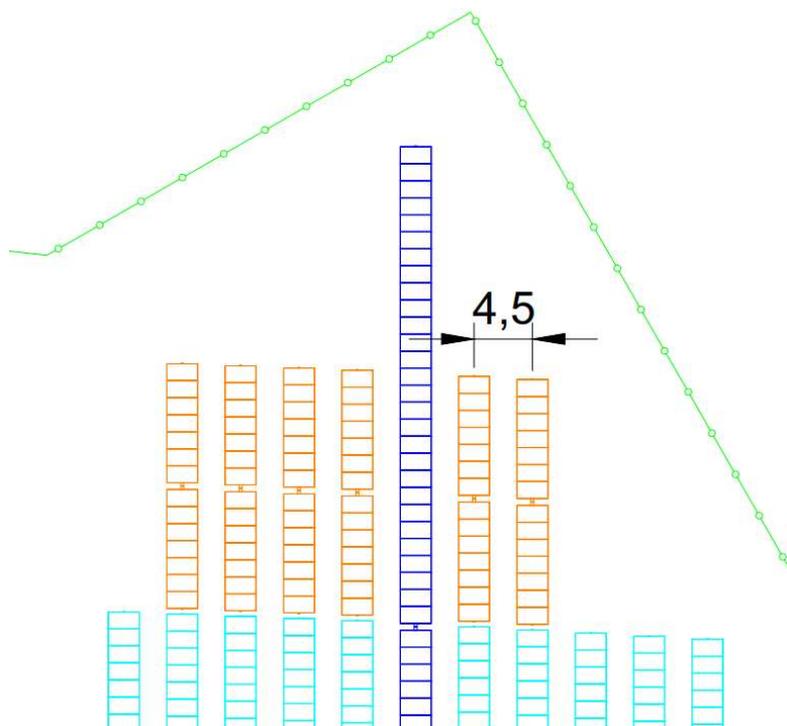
Layout impianto fotovoltaico in funzione di riferimento, distanza tra strutture adiacenti
